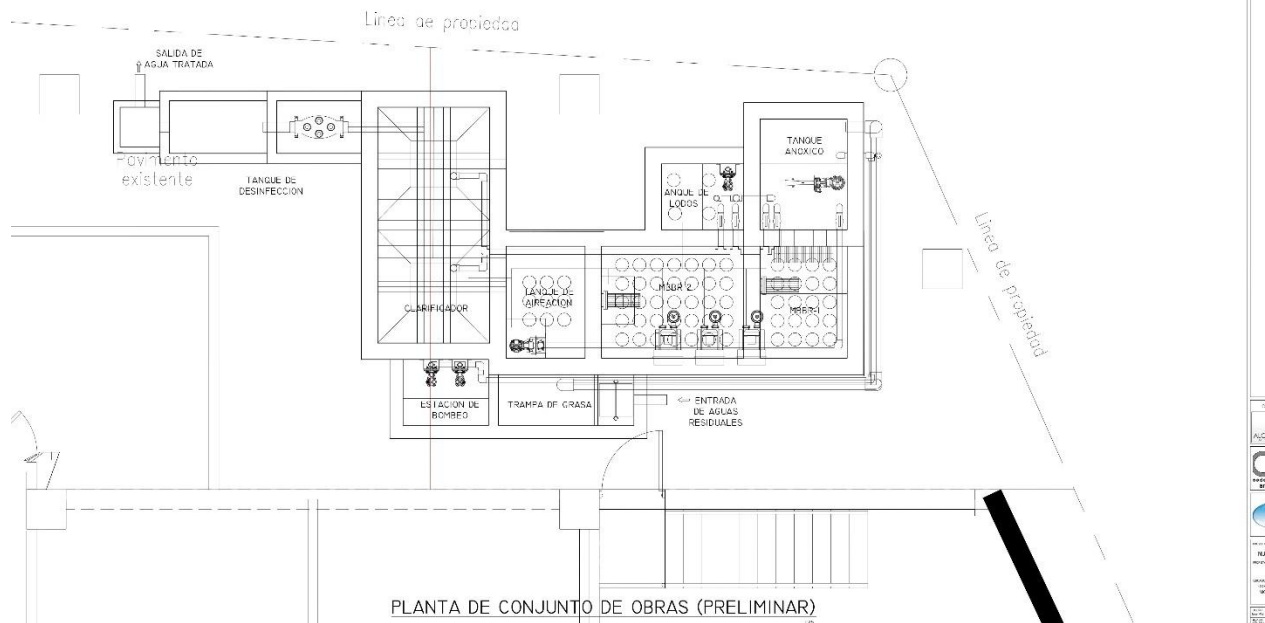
Planta de Conjunto de Obras. Anexo 14.9.
